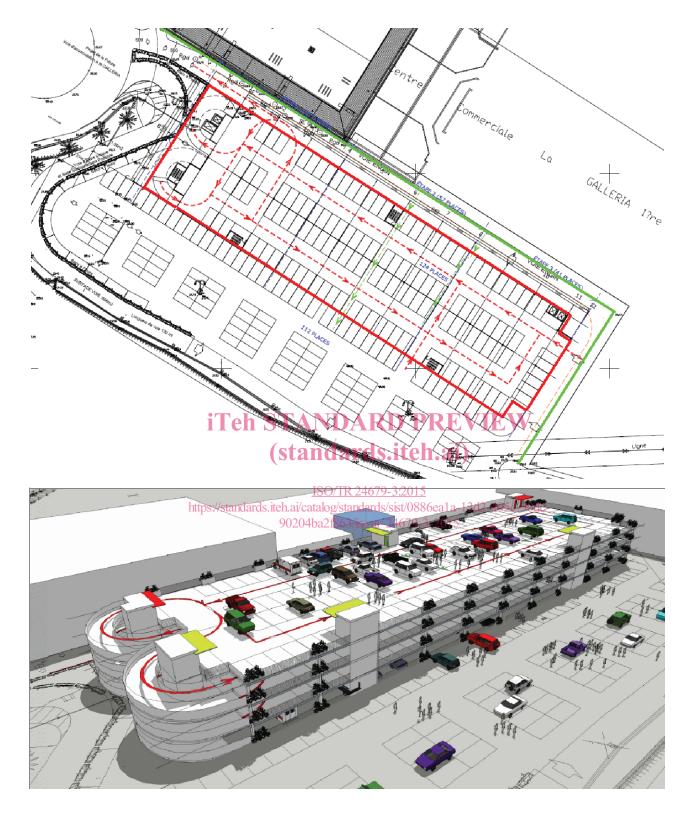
Vues du parking aérien largement ventilé étudié : vue en plan (image du haut) et vue en perspective (image du bas)
